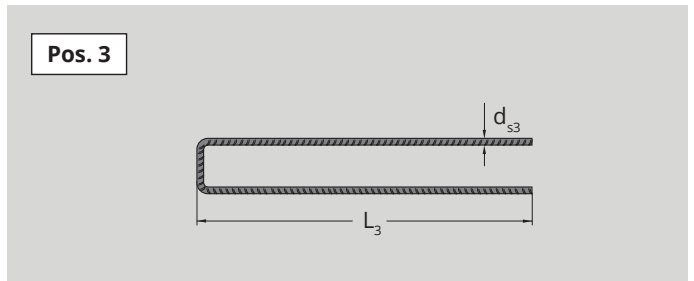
Zusatzbewehrung „symmetrische Querkzugbewehrung“
